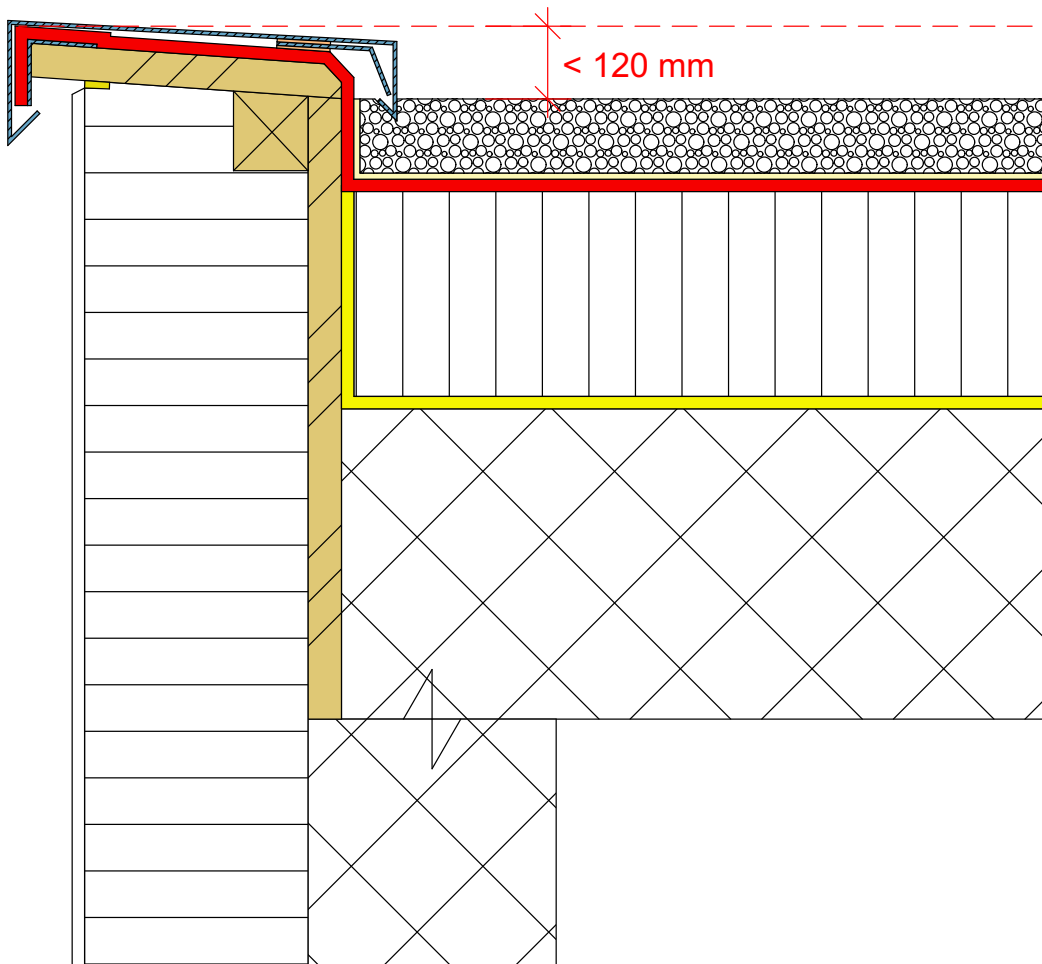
Überlaufsichere Dachrandkonstruktionen
